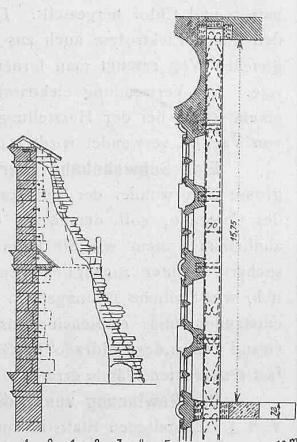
Grundriss und Schnitt. — Masstab 1 : 300.
